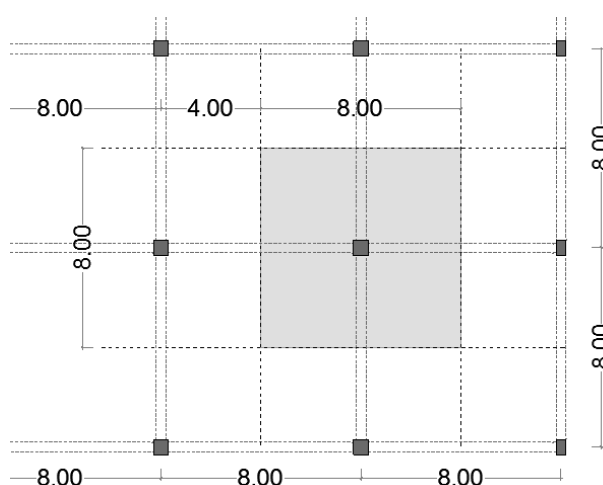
Área tributaria para dimensionamiento de columna céntrica- caso 2
